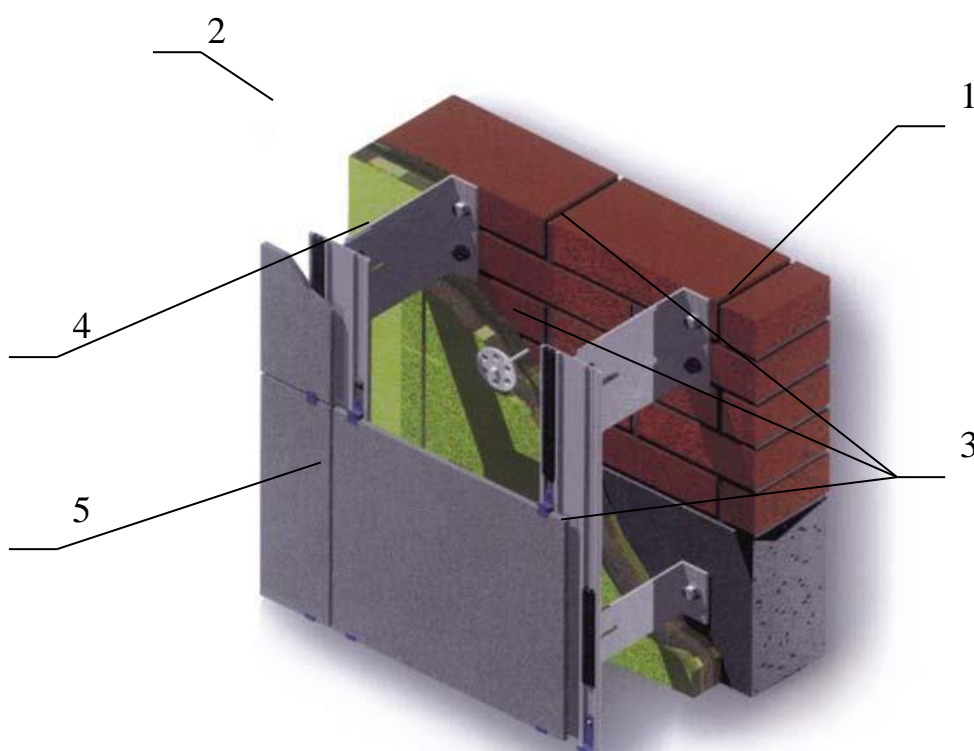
Конструкція навісного вентильованого фасаду. 1 – несуча стіна; 2 - теплоізоляційний шар; 3 - під облицювальна конструкція; 4 - повітряний проміжок; 5 - облицювання
